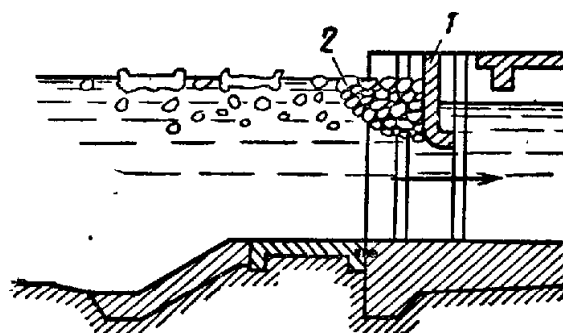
Водозаборное сооружение с забральной стенкой: 1–забральная стенка; 2 – «клин» из остановленной шуги (или плавника).
